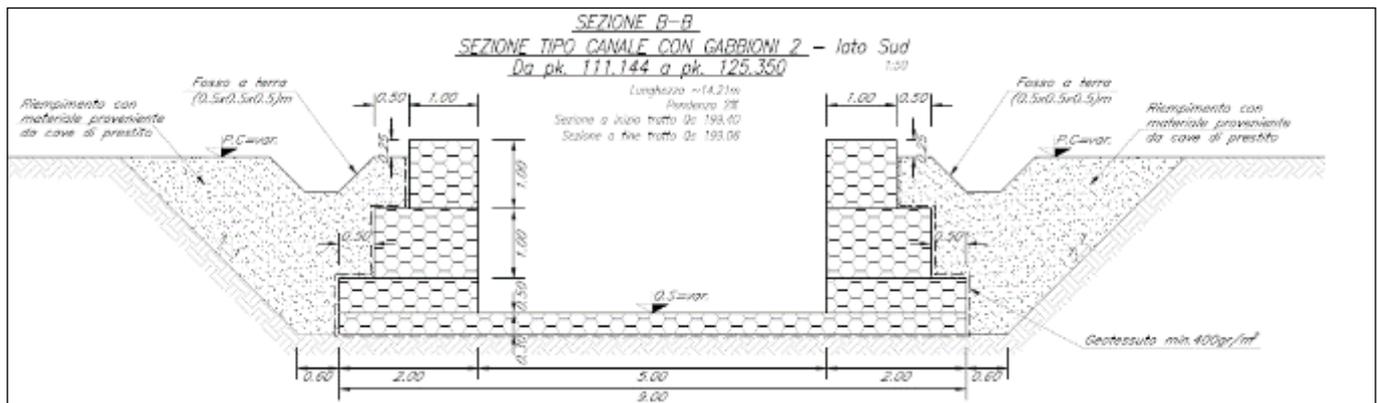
Sezione di canale nel tratto a monte tra gabbioni
